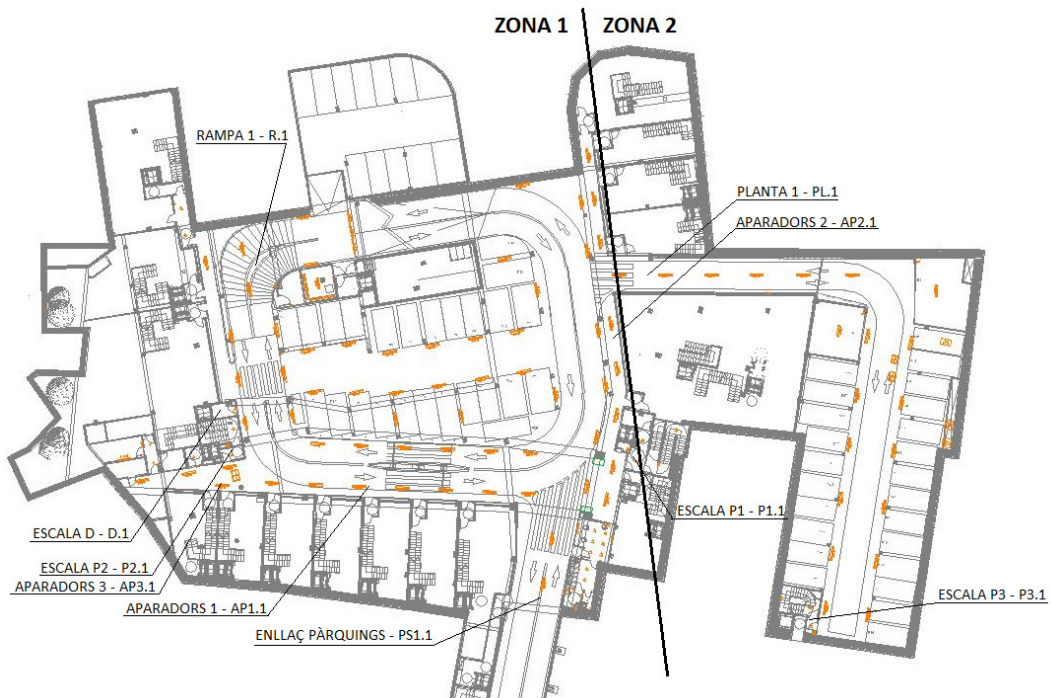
Plànol d'ubicació de detectors en la planta -1
